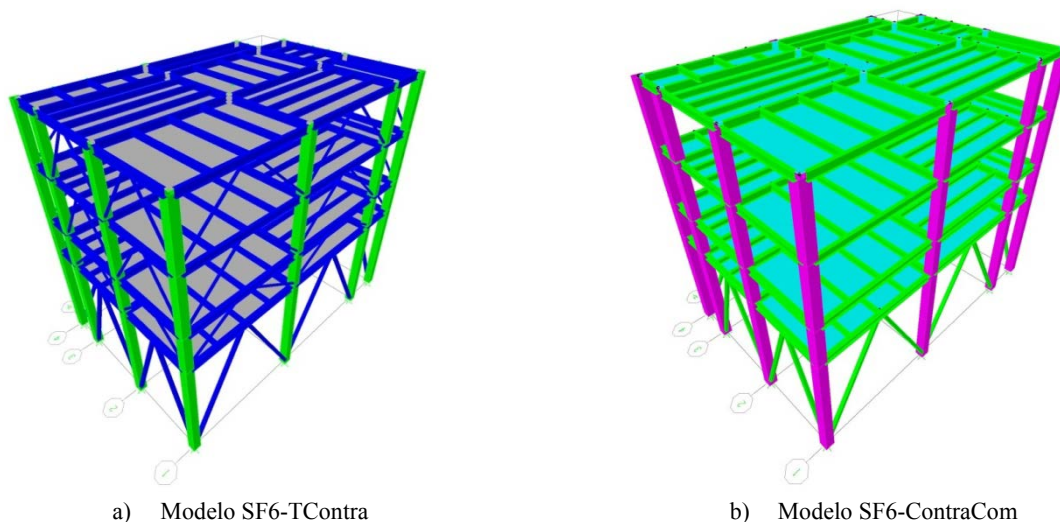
Modelos tridimensionales en ETABS de opciones de estructuración adicionales.
